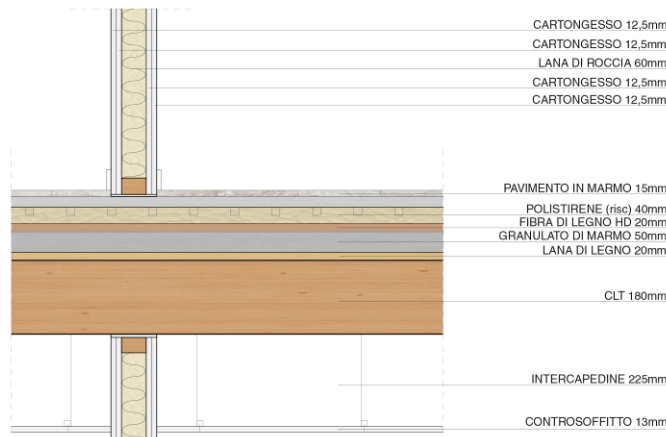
Dettaglio costruttivo della parete interna con il solaio - Floor and inside wall structural junction detail.
